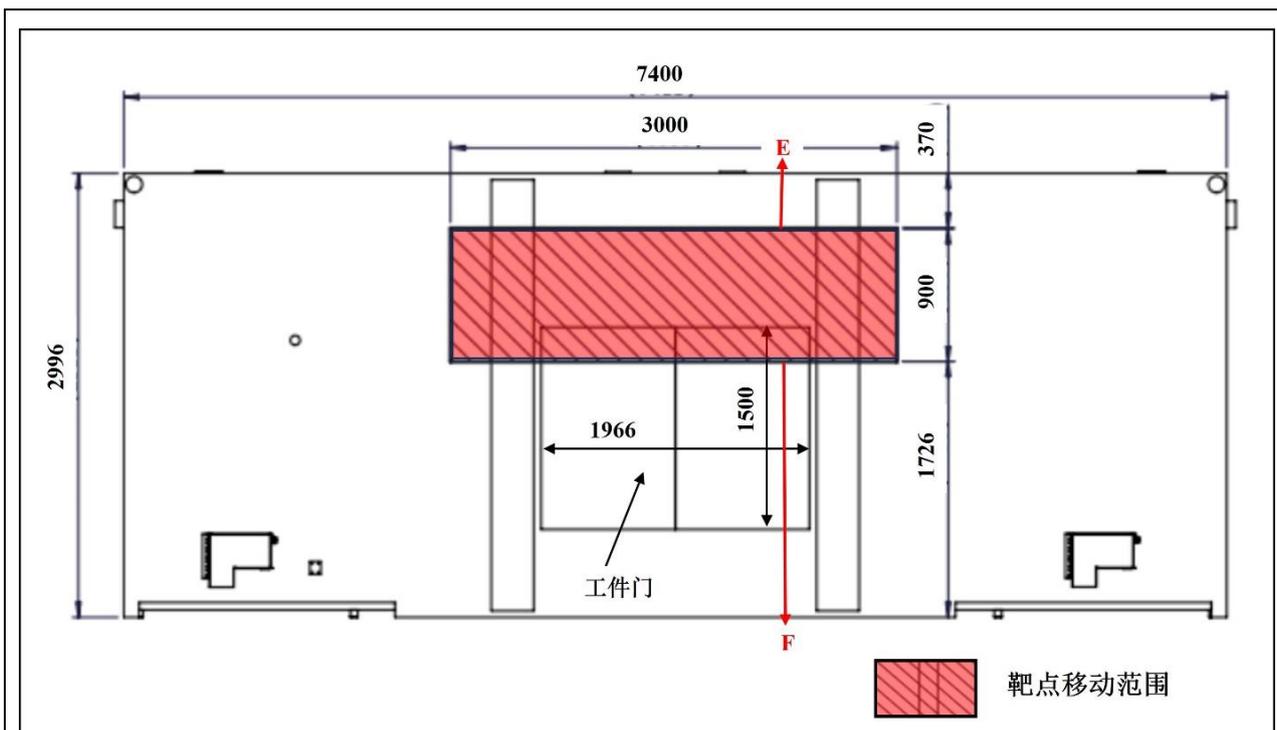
辐射屏蔽计算预测点位剖面图 (单位: mm)
